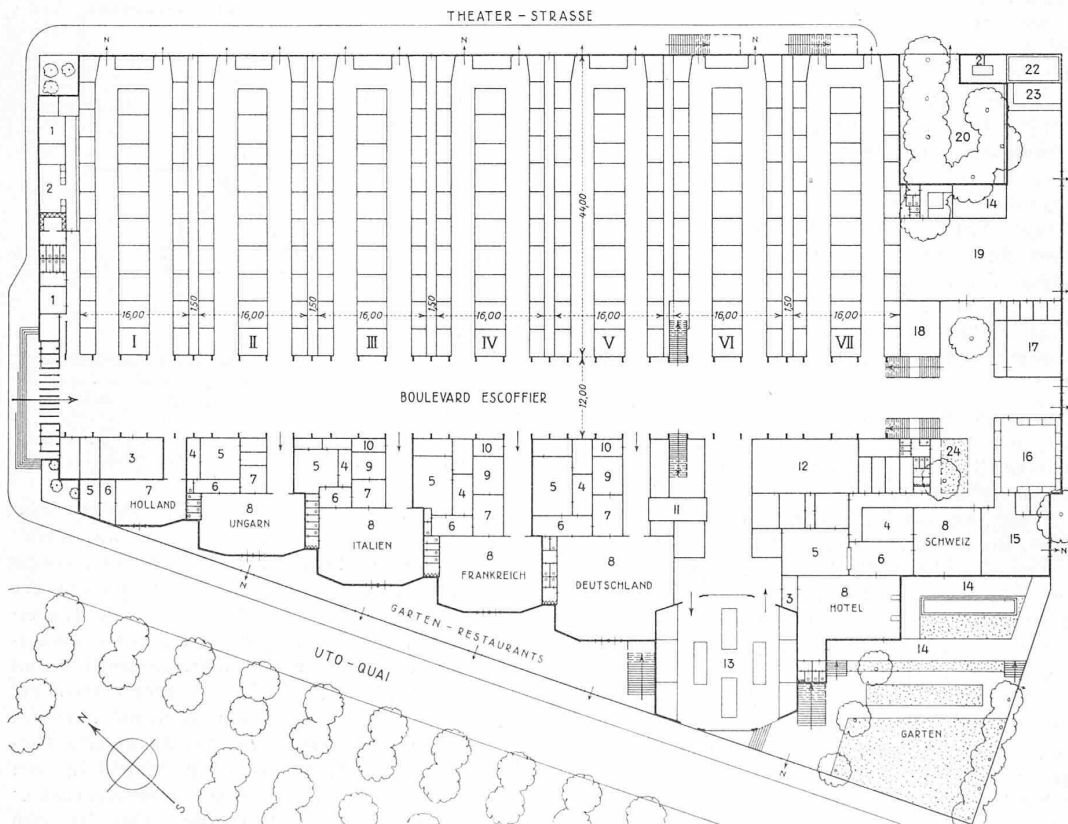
Grundriss 1:1000. — Legende: 1 Bureaux, 2 Presse, 3 Garderobe, 4 Keller, 5 Küche, 6 Office, 7 Bar, 8 Restaurant, 9 Salon, 10 Publizistik, 11 Tabak, 12 Ausstellungsküche, 13 Kochkunst, 14 Terrassen, 15 Fischküche, 16 Lebende Fische, 17 Metzgerei, 18 Bäckerei, 19 Bierhalle, 20 Biergarten, 21 Militärküche, 22 Bierkeller, 23 Buffet, 24 Gartenhöfchen. — I bis VII Ausstellungshallen, N Notausgänge.
